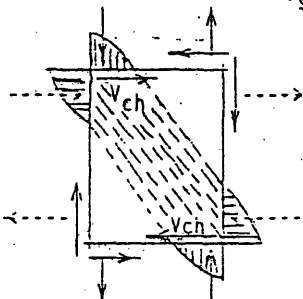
Οφέλιμο πλάτος κόμβου
